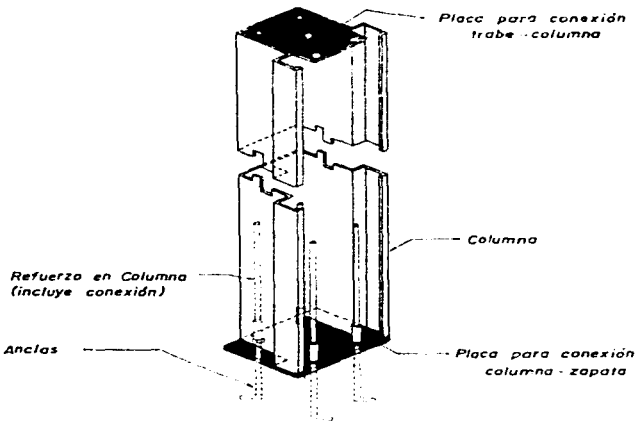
Detalle de los Elementos Integrantes de una Columna
